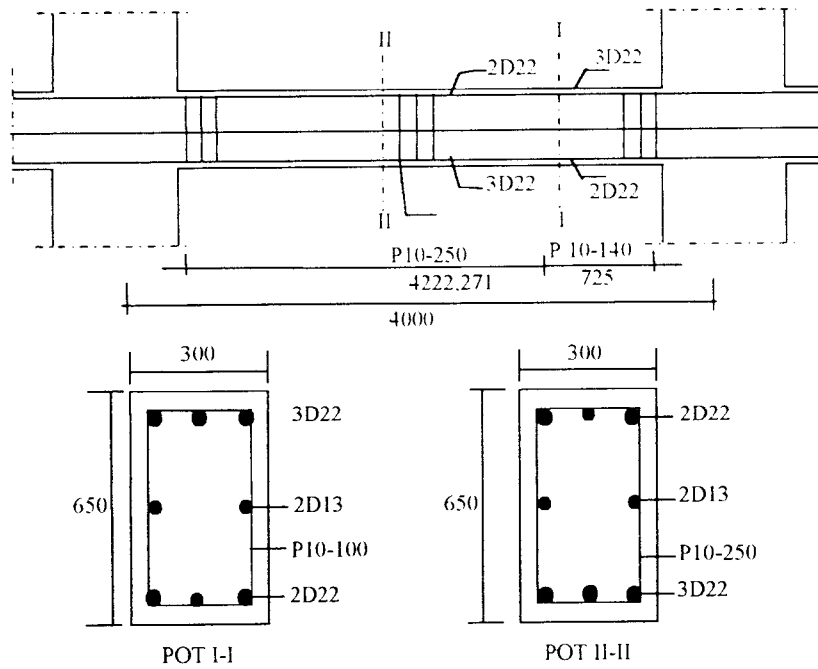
Balok Portal E Bentang 4 m Lantai 10
